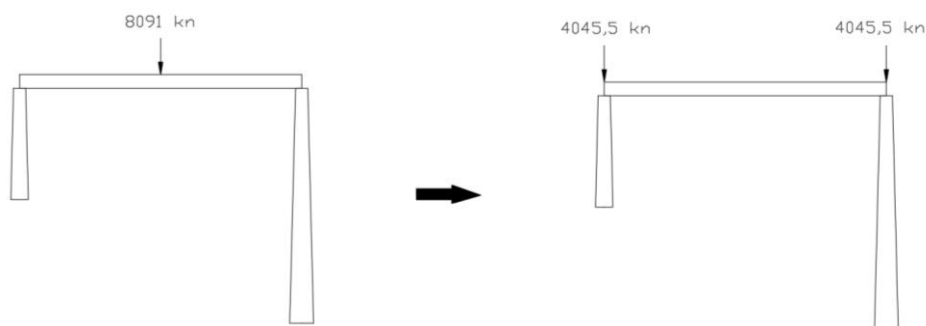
Cargas puntuales en Pila 1 y Pila 2
